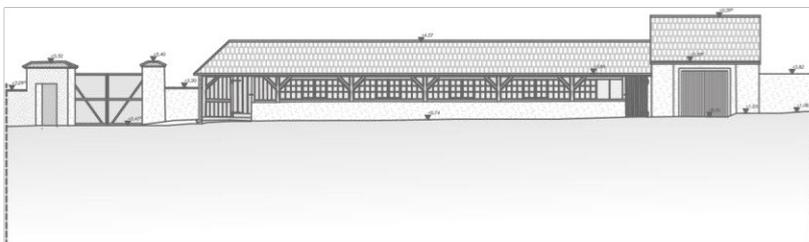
Bestandsplan Ansicht West Kegelbahn- Übersichtsplan
